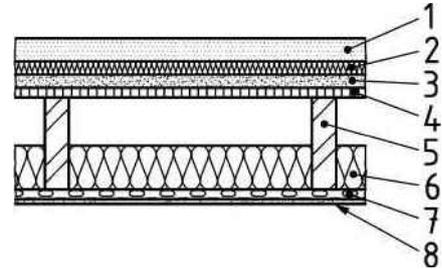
Deckenkonstruktion der Wohnungstrenndecke
